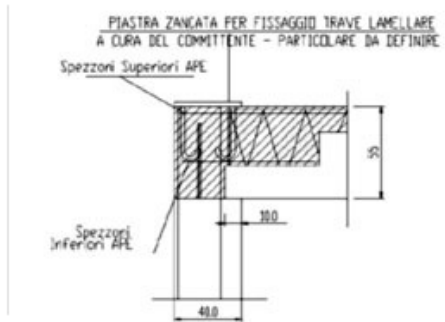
Schema di appoggio delle travi sui pilastri di bordo con piastra per il fissaggio dell'orditura primaria della struttura lignea.
